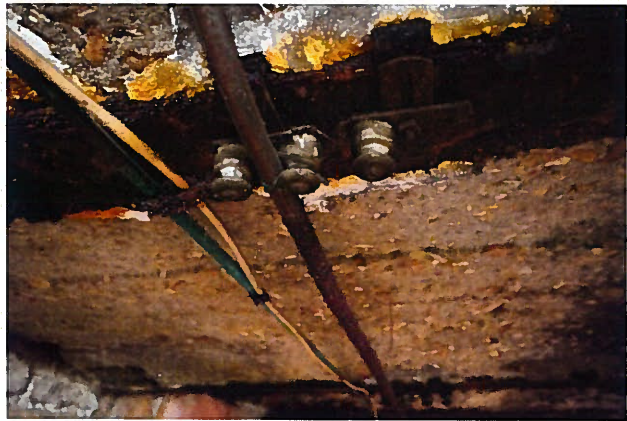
, Raum U.1B.42 Decke, Stahlträger mit Resten der Elektroanlage um 1945, Sept. 2017
